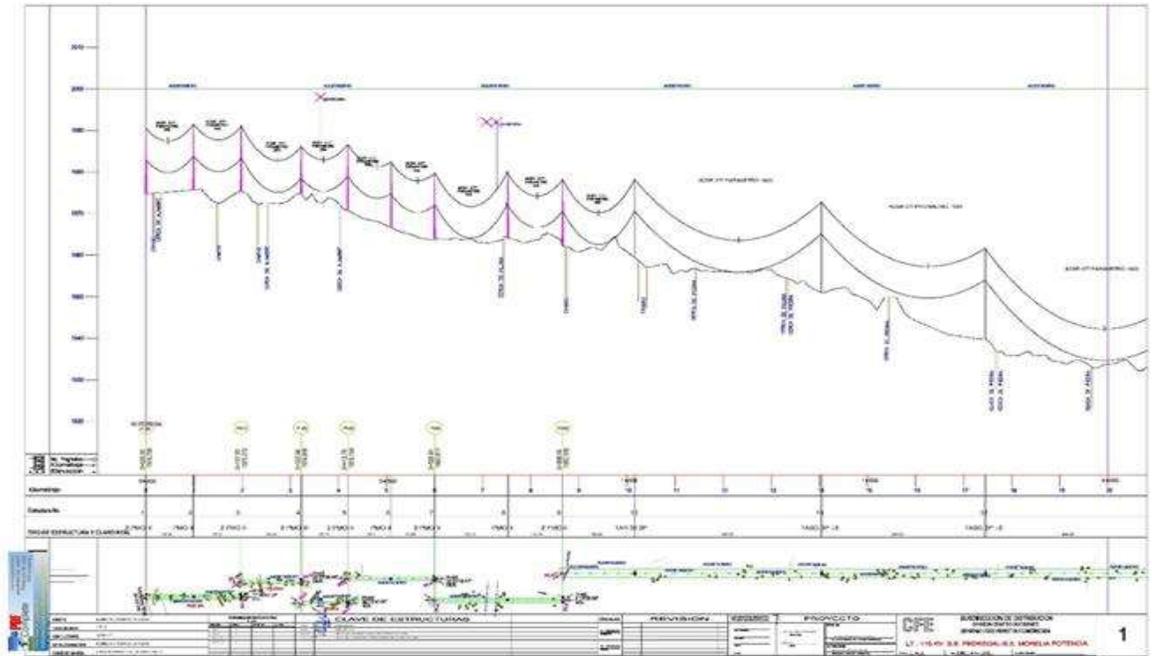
PLANO DE PLANTA Y PERFIL DE LA TRAYECTORIA DE LA LÍNEA
